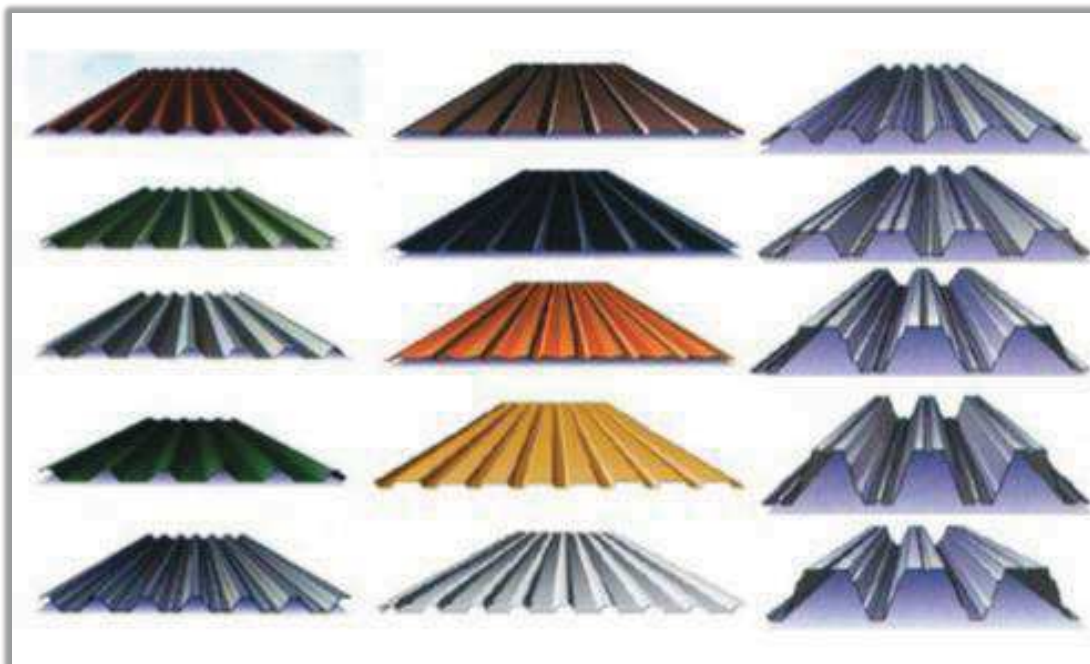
Exemples des tôles ondulées pour les toitures, revêtements muraux et planchers.
